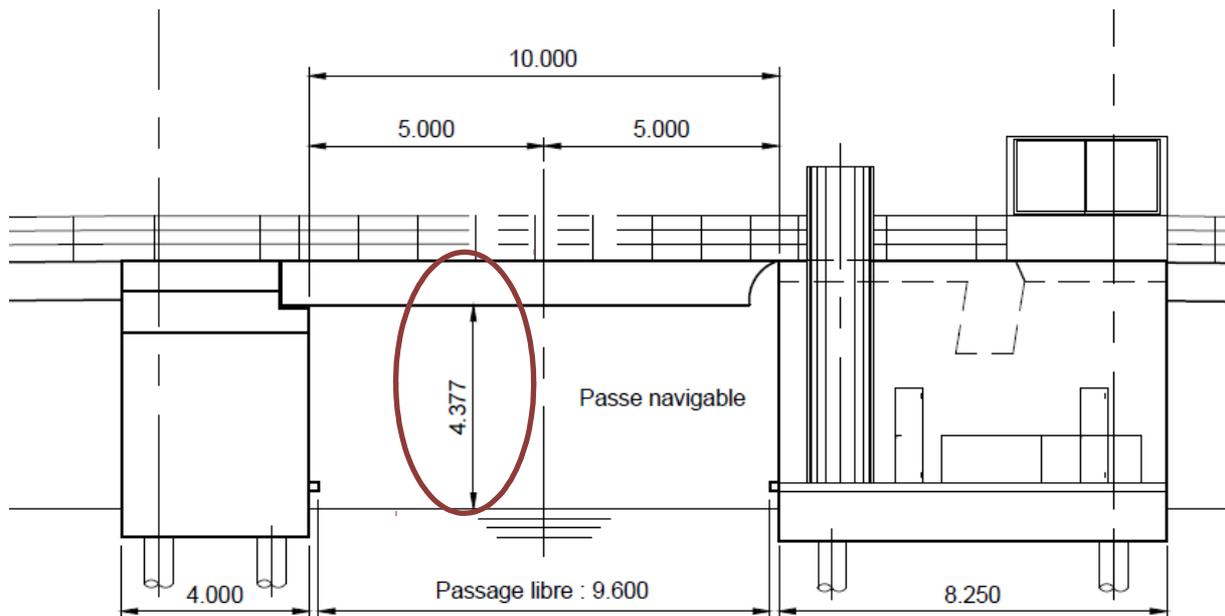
Extrait de la coupe longitudinale du pont de la Gabarre
